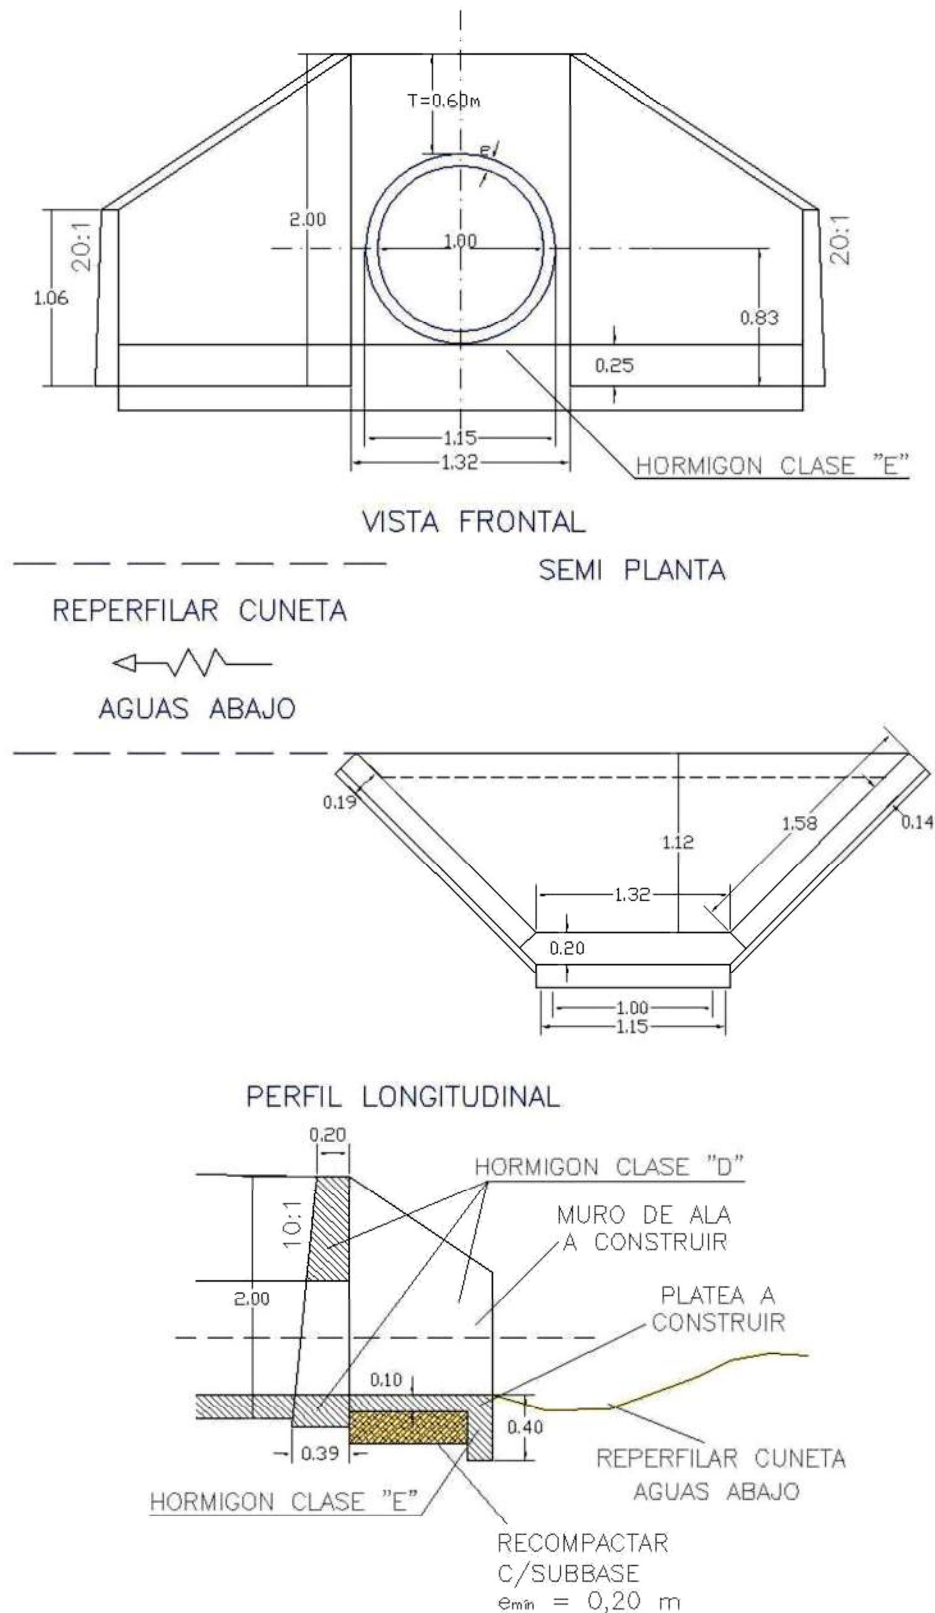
Detalle de cabezal de egreso a alcantarilla, a construir.
